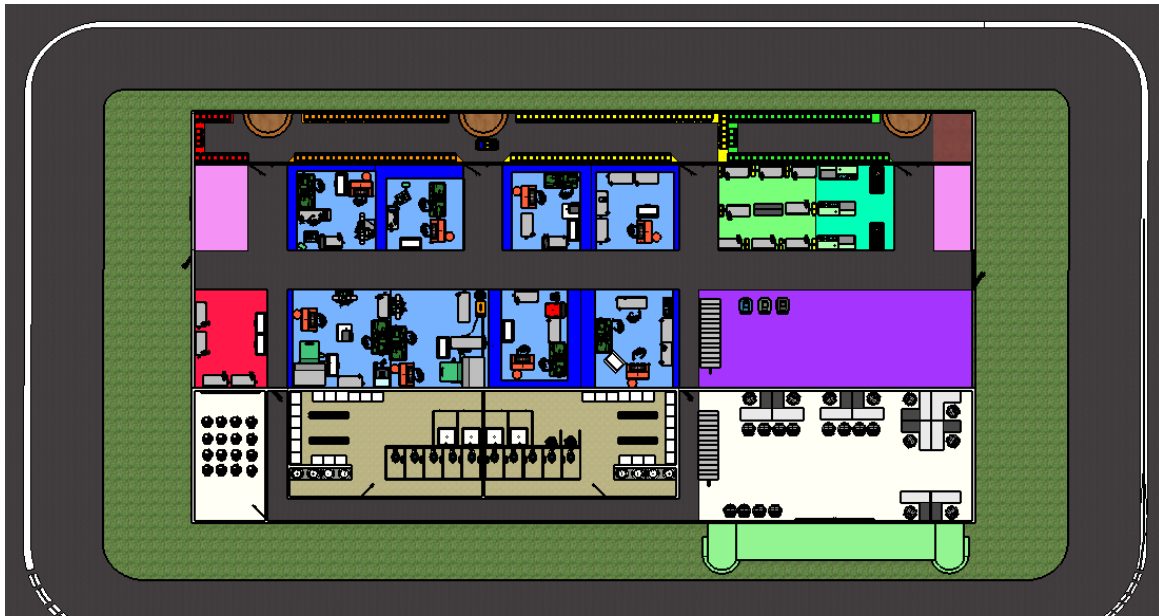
Distribución de Planta en Detalle – 1er Piso – Vista Superior
